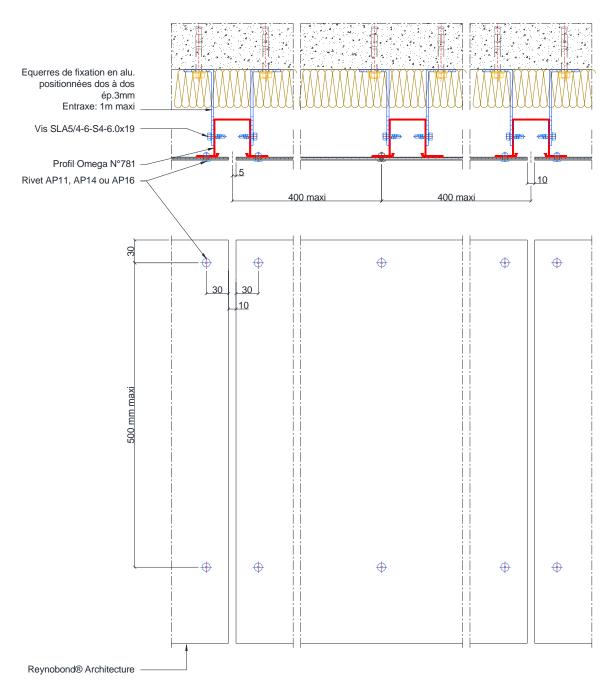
Pose en sous-face de dalle - Système riveté RV 50 2c
